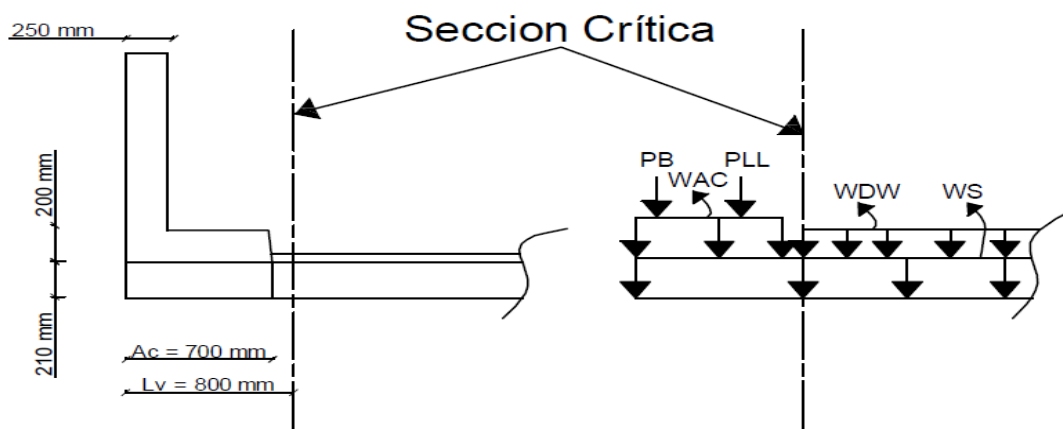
Sección crítica de los volados con las cargas que actúan. Elaborado por: Autor.
